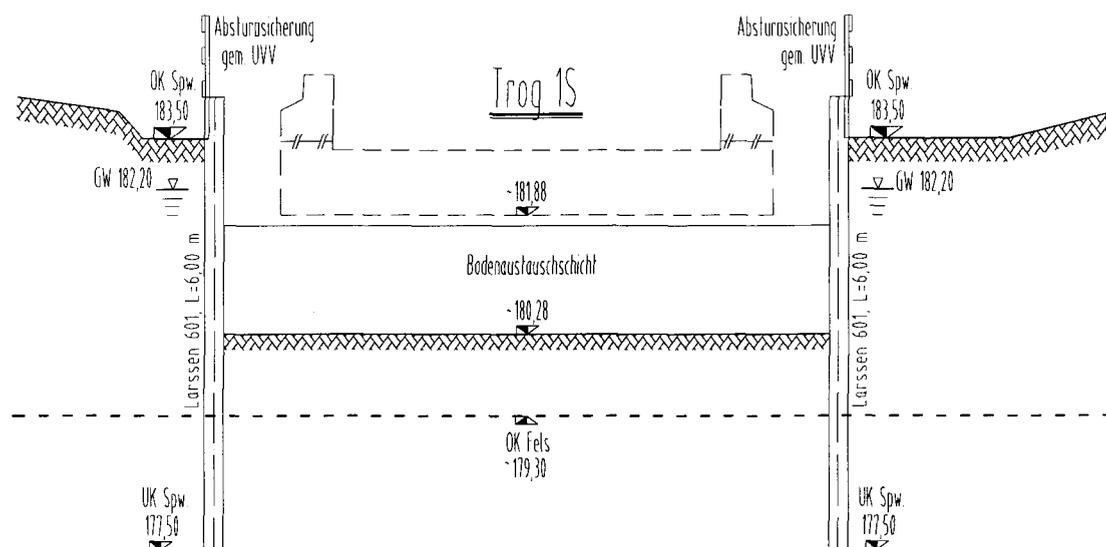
Querschnitt & Grundriss (Trog 1S)
